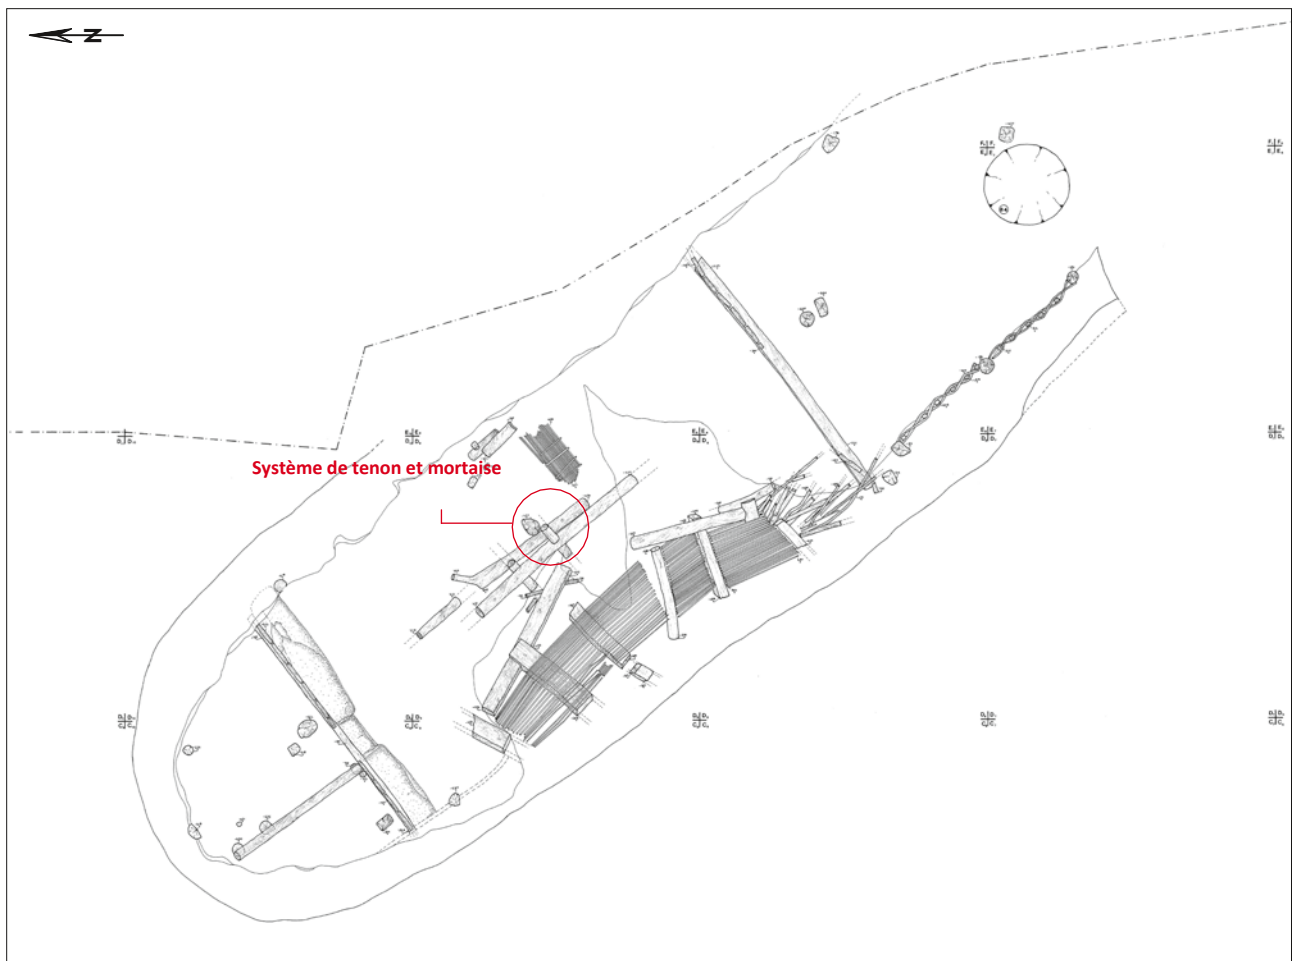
Nola-Croce del Papa. Plan de la Maison 4 avec paroi écroulée (en évidence, système d'emboîtement avec tenon et mortaise).
